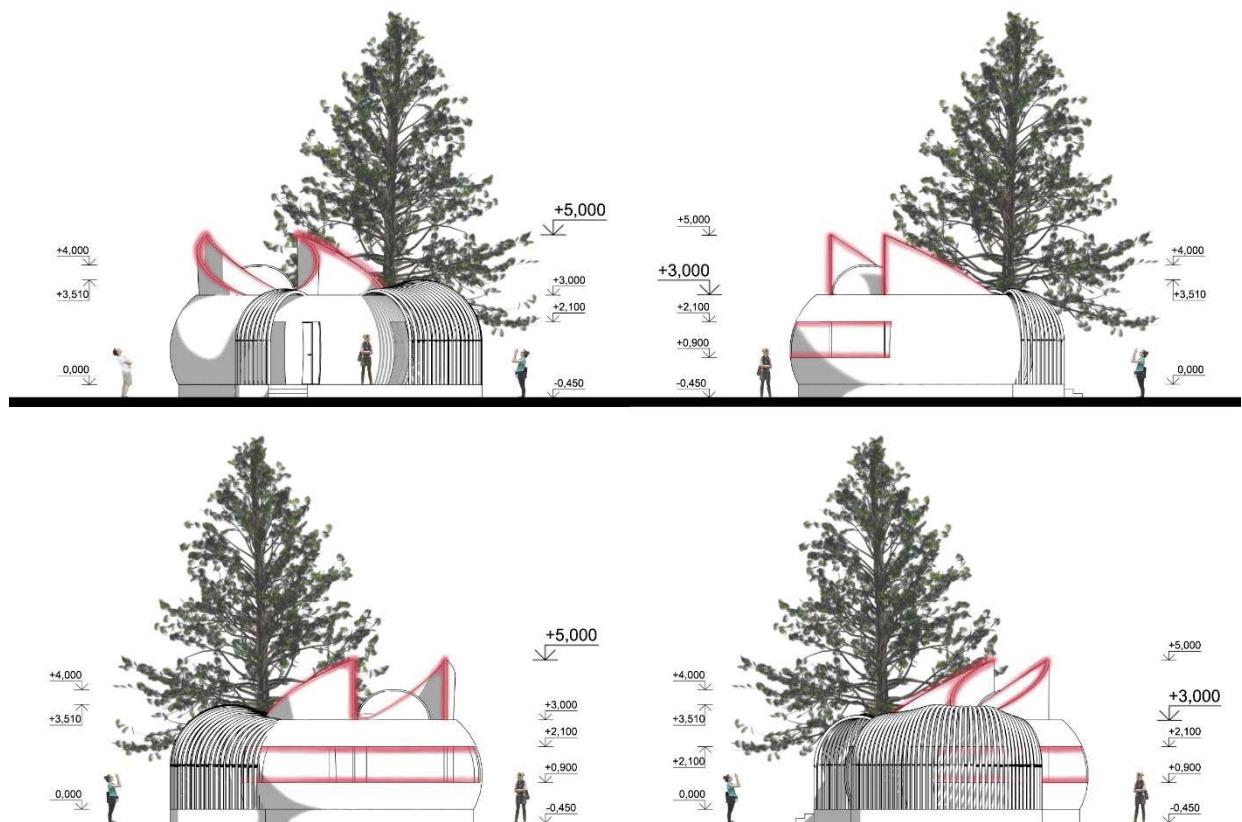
Фасады жилого дома «Светлячок», красным цветом показана подсветка
